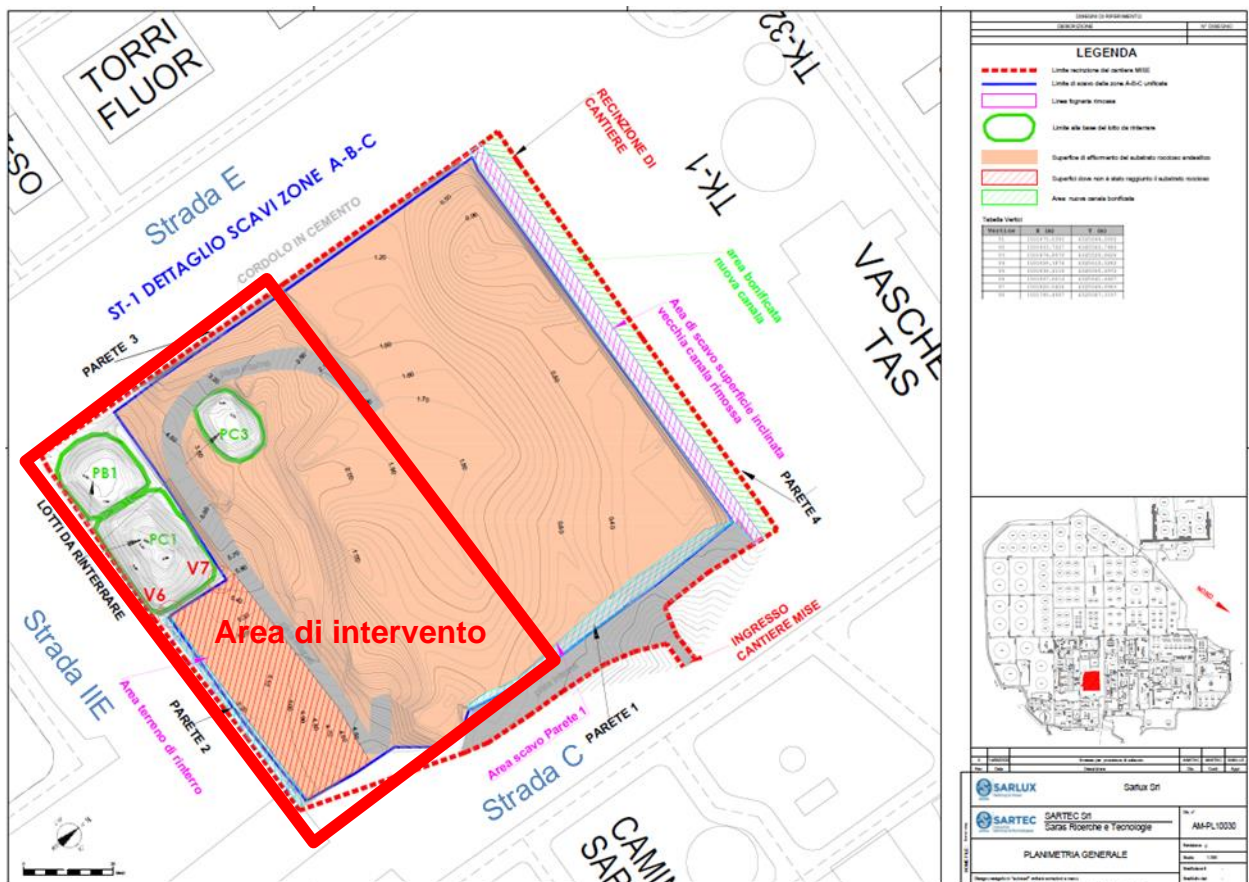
Planimetria area scavi MISE area ex serbatoio ST-1
